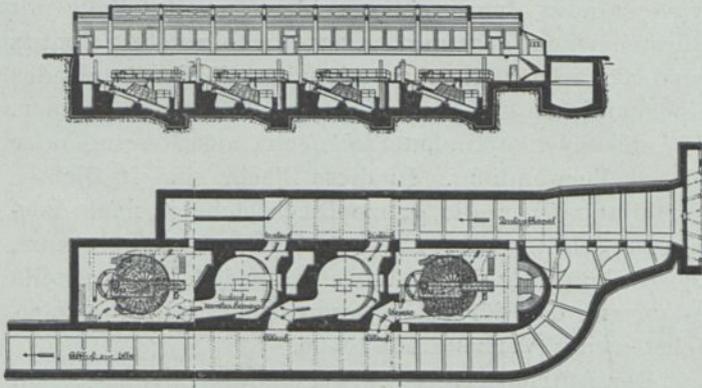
Dresdner Abwasser-Reinigungsanlage mit Riensch'schen Separatorscheiben.
